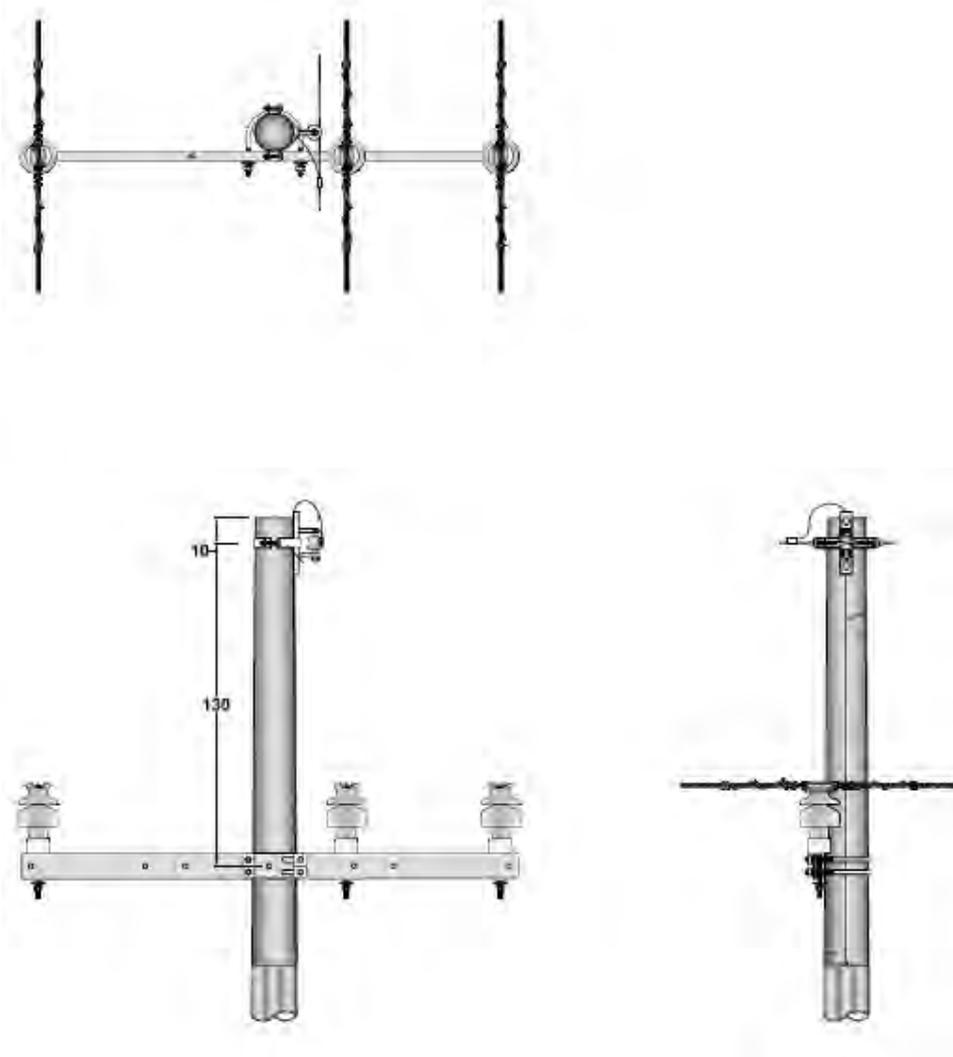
Torres tipo (postes de concreto tipo TSG3).
